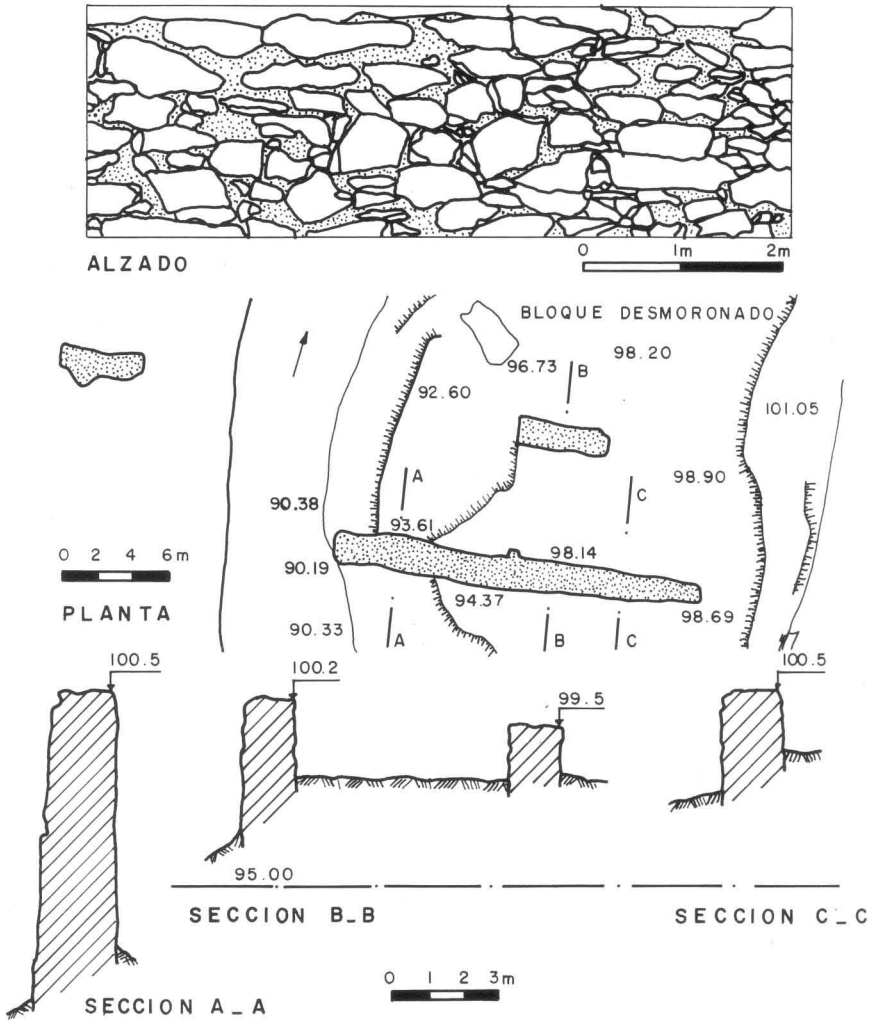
Represa. Planta, secciones y alzado parcial del paramento interior del muro principal.
